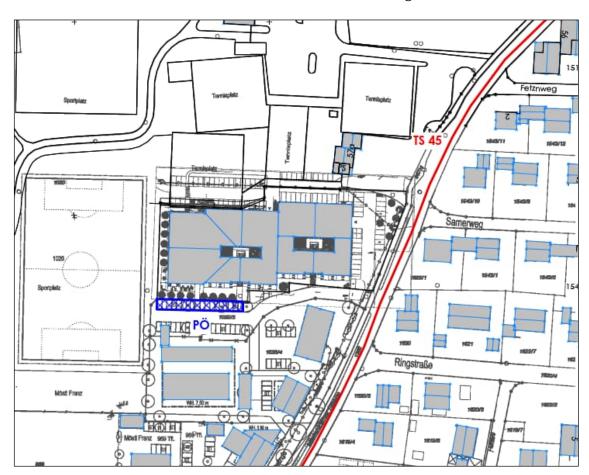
Lageplan mit Darstellung der Kreisstraße im relevanten Bereich
